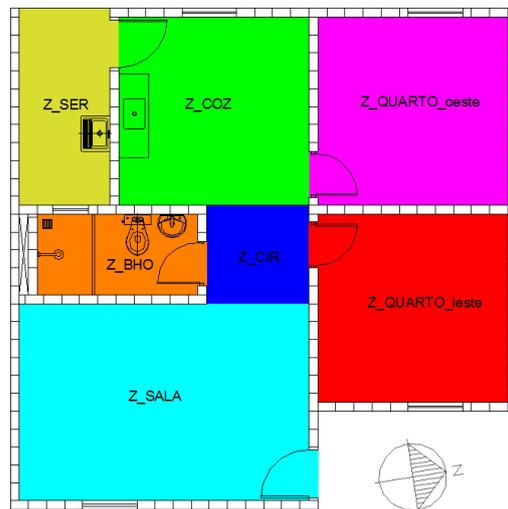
Planta baixa em zonas térmicas da tipologia sobrado urbano térreo
